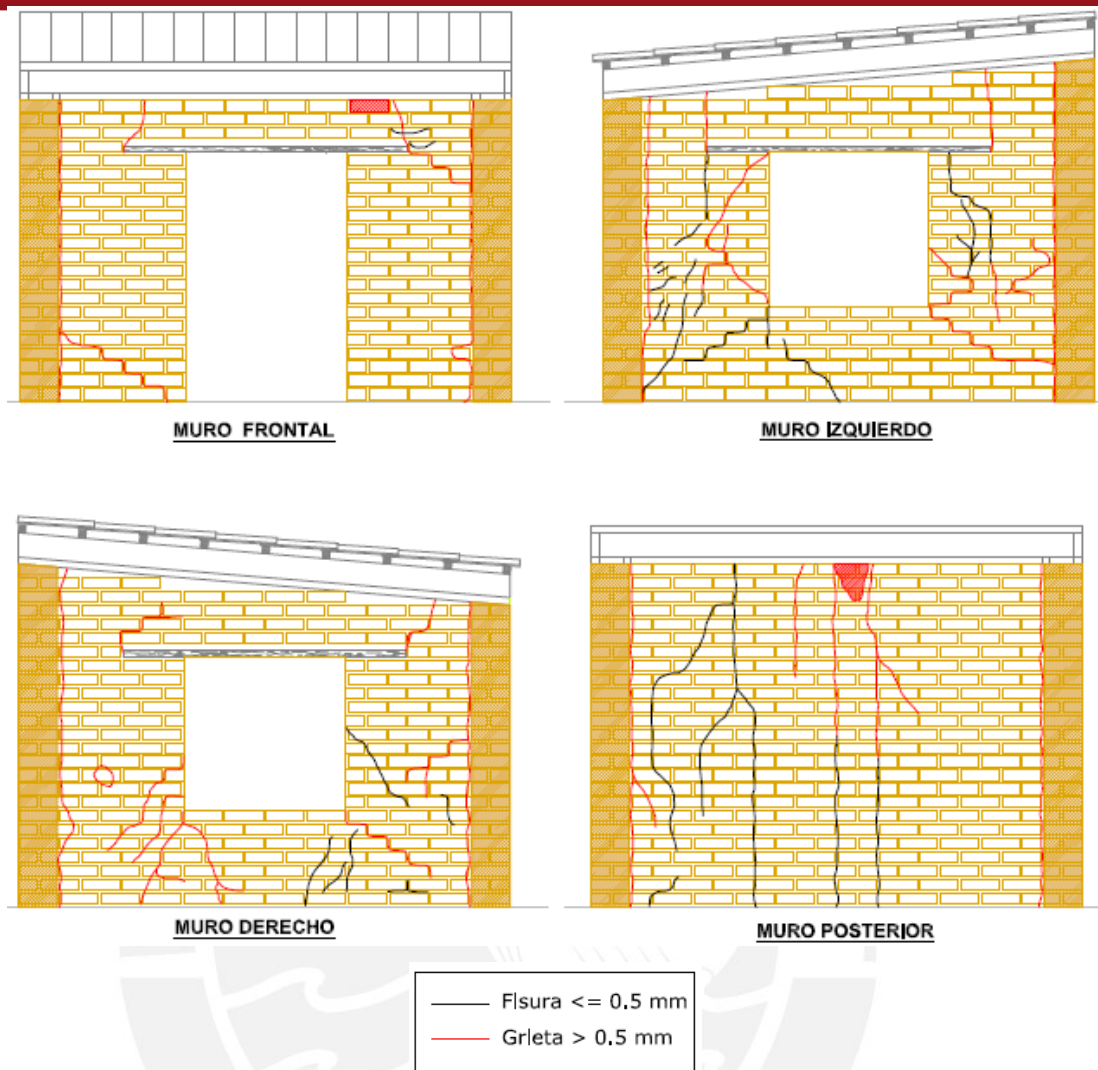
Fisuras y grietas interiores en muros – Módulo M100-T4100
